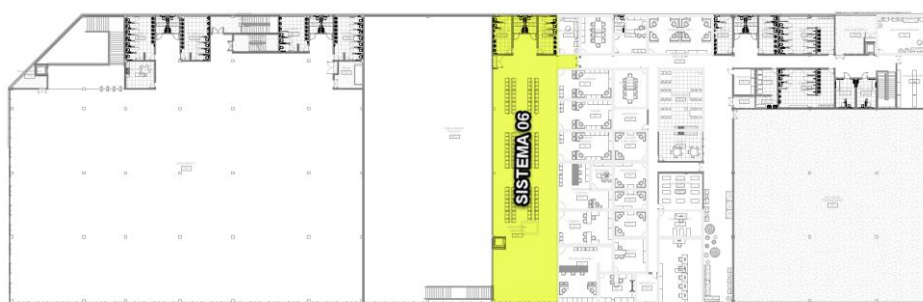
Sistema 06 (1º Pavimento – Lado Leste)
